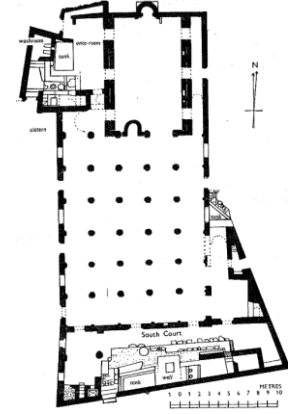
مسقط أفقي لمسجد سنديني/كينيا
